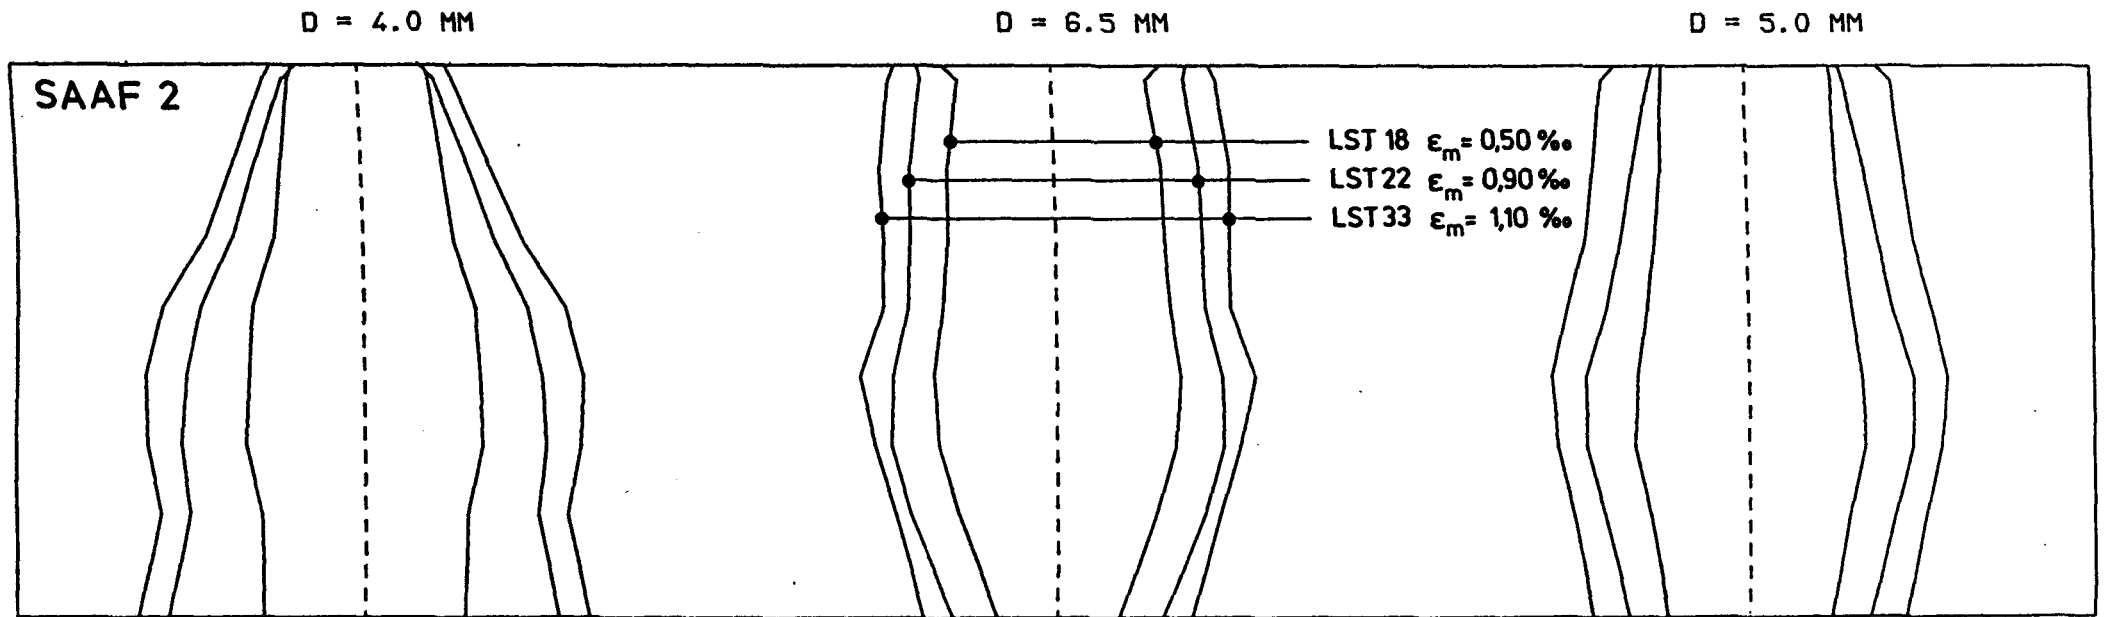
RISSBREITEN IN LASTSTUFE 18 22 33
